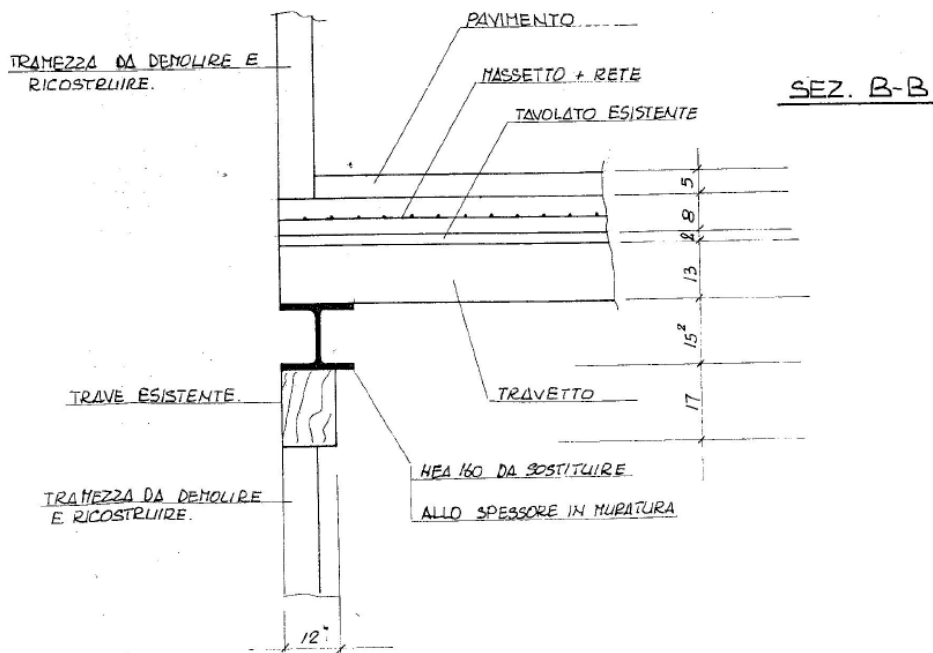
Torre: sezione B-B solaio ligneo di piano - intervento di consolidamento (Mezzadri, 1970)
